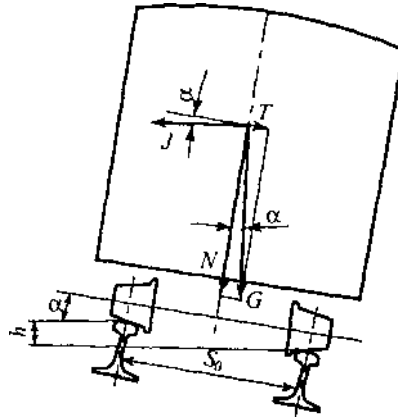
Расчетная схема для определения возвышения наружного рельса в кривых:
